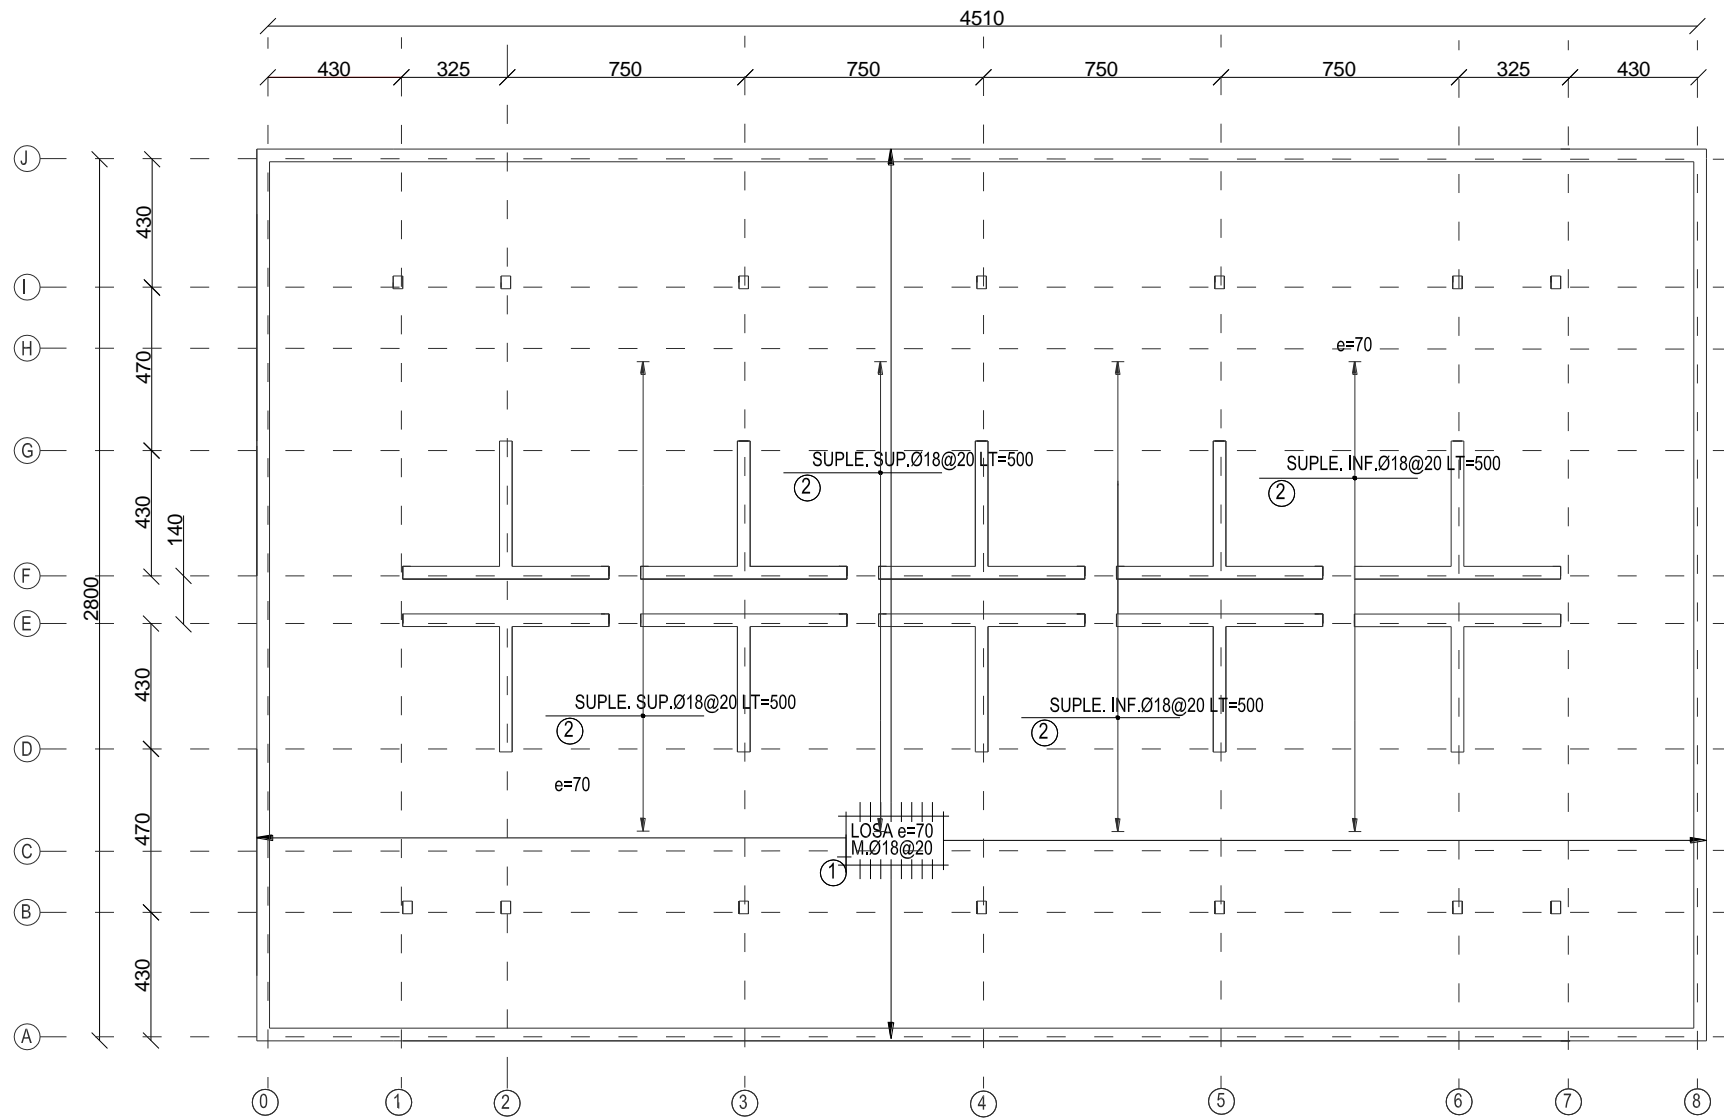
Planta losa de fundación armadura superior de edificio tradicional.
